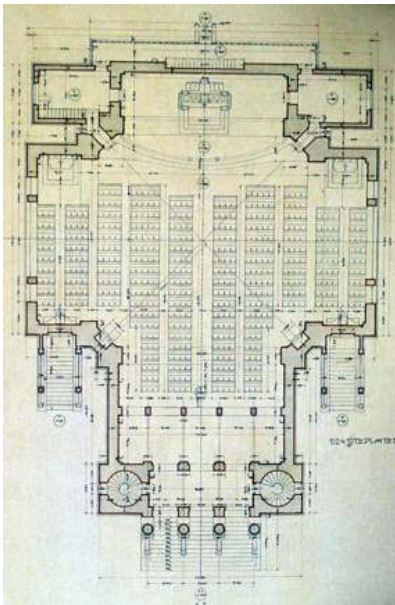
y 54.- Planta y alzado de la Kirche am Steinhoff.
